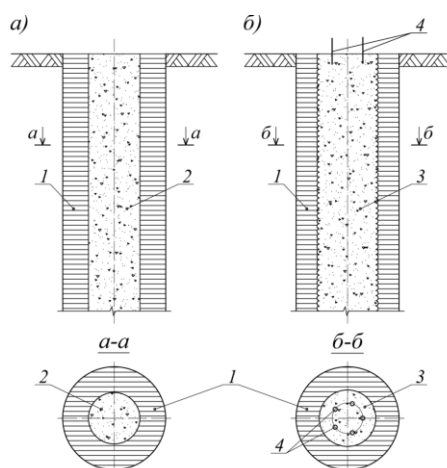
Схема устройства грунтобетонной сваи (ГБС).
